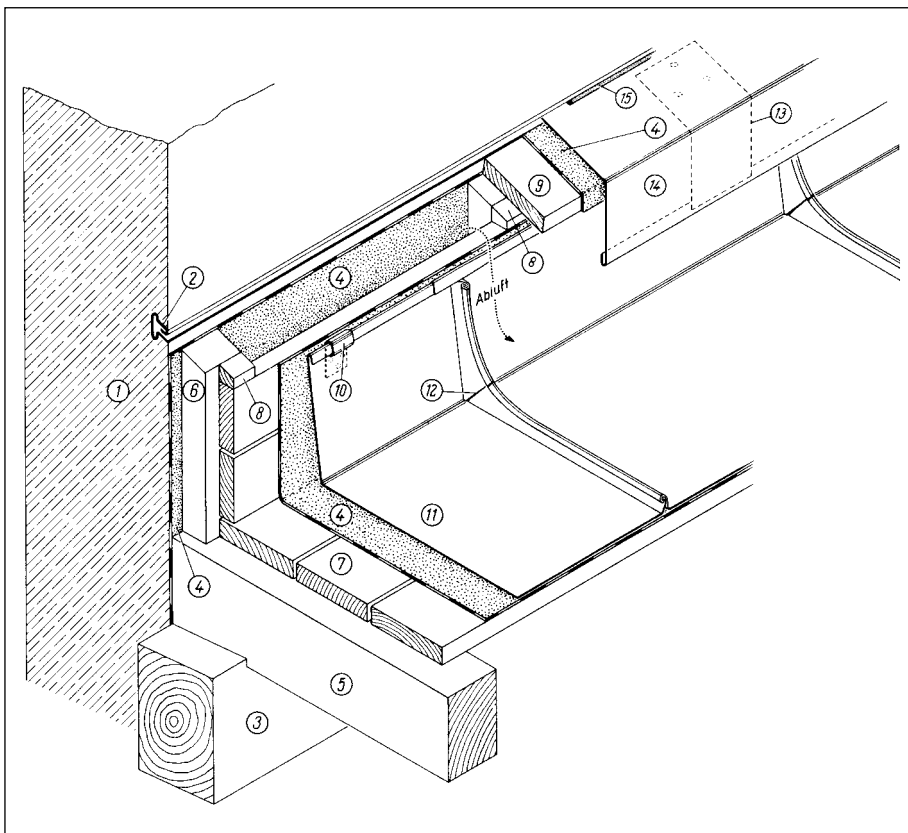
Wandanschluß mit Entlüftung (oberer Anschluß). 1 Wand; 2 GT-Profilsschiene; 3 Pfette; 4 Trennschicht; 5 Sparren; 6 Leiste (Abstandsholz); 7 Holzschalung; 8 Stützklotz für 9 Auflagenbrett für Kappleiste; 10 Haft; 11 Doppelstehfalzdeckung; 12 Quetschfalte; 13 Haft- bzw. Vorstoß; 14 Kappleiste; 15 Einschub- bzw. Klemmprofil zur GT-Profilsschiene.
